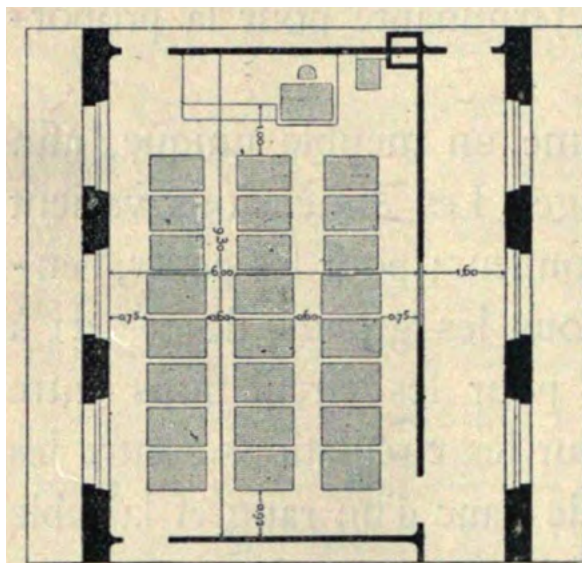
Plan d'une classe à éclairage unilatéral.
